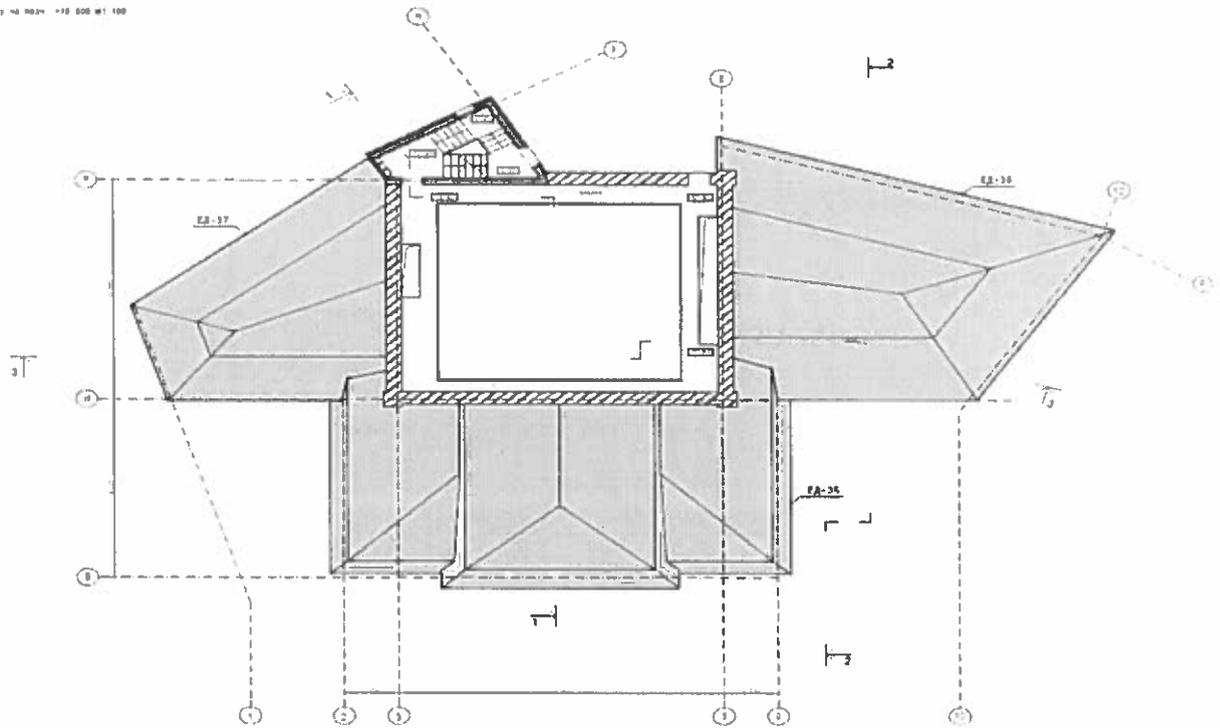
План будівлі на відмітці +10,800 [2]
